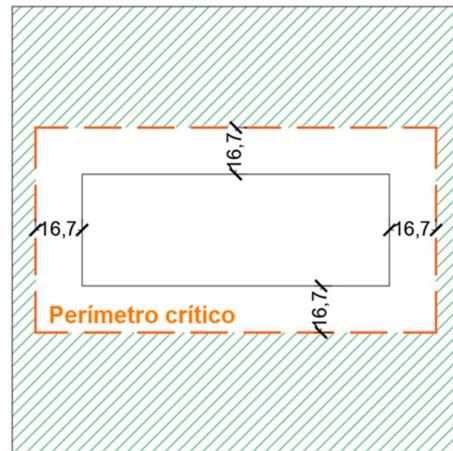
| Perímetro crítico de la zapata a corte en dos direcciones. Fuente: Elaboración propia.
